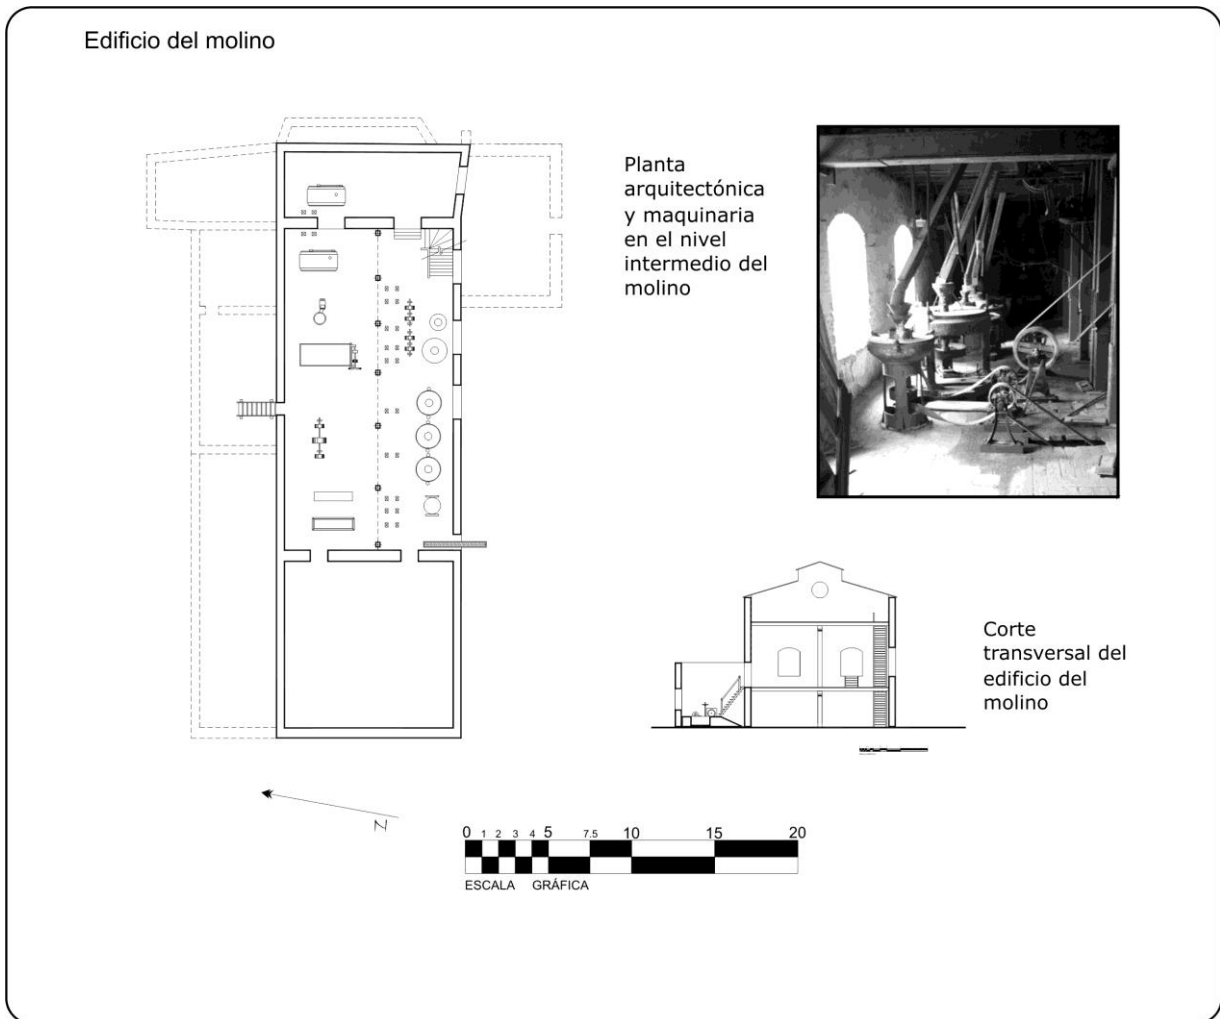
Planta arquitectónica del molino de Lombardía. Fuente: elaboración propia.
